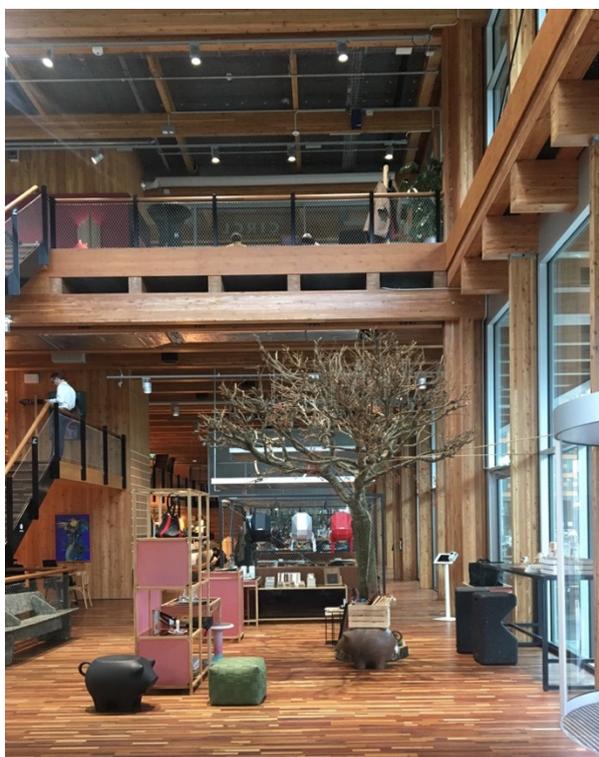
Vista interna del Circl Pavillion: pavimento di legno riutilizzato e mancanza del controsoffitto con impianti a vista
